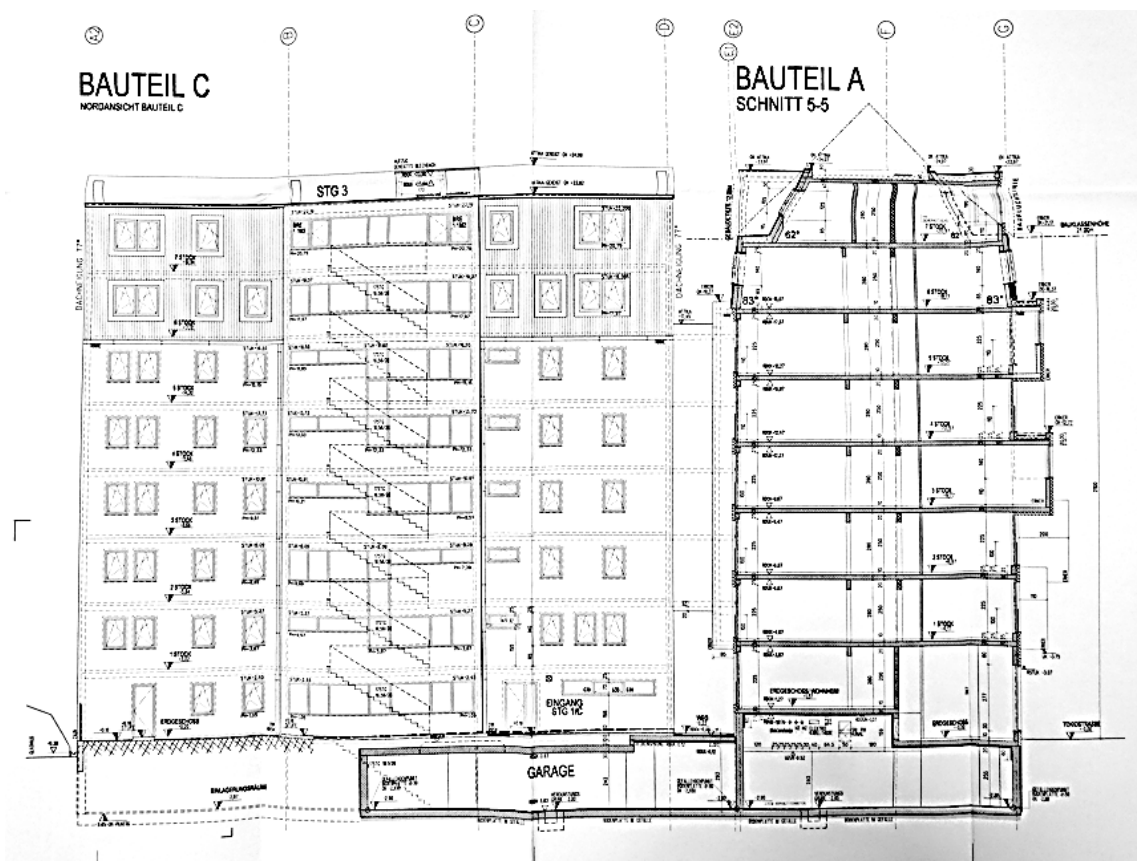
Auszug Bestandsplan (Fertigstellungsanzeige), Plan Nr.: 11
